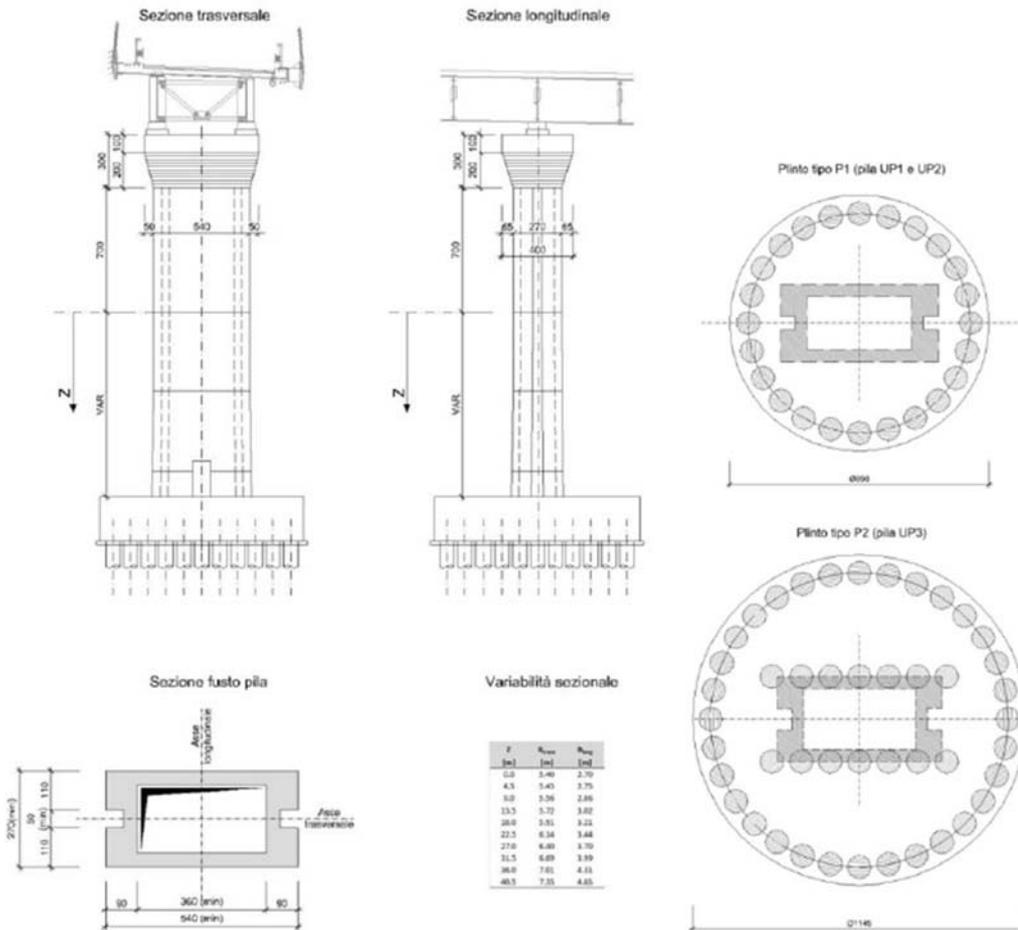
Inquadramento generale geometria pile e fondazioni Viadotto A
